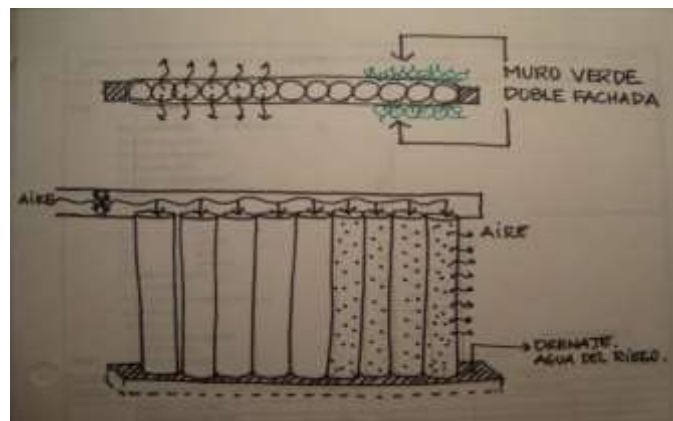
armado del sistema de tubos para conformar un muro vegetal ventilado.
